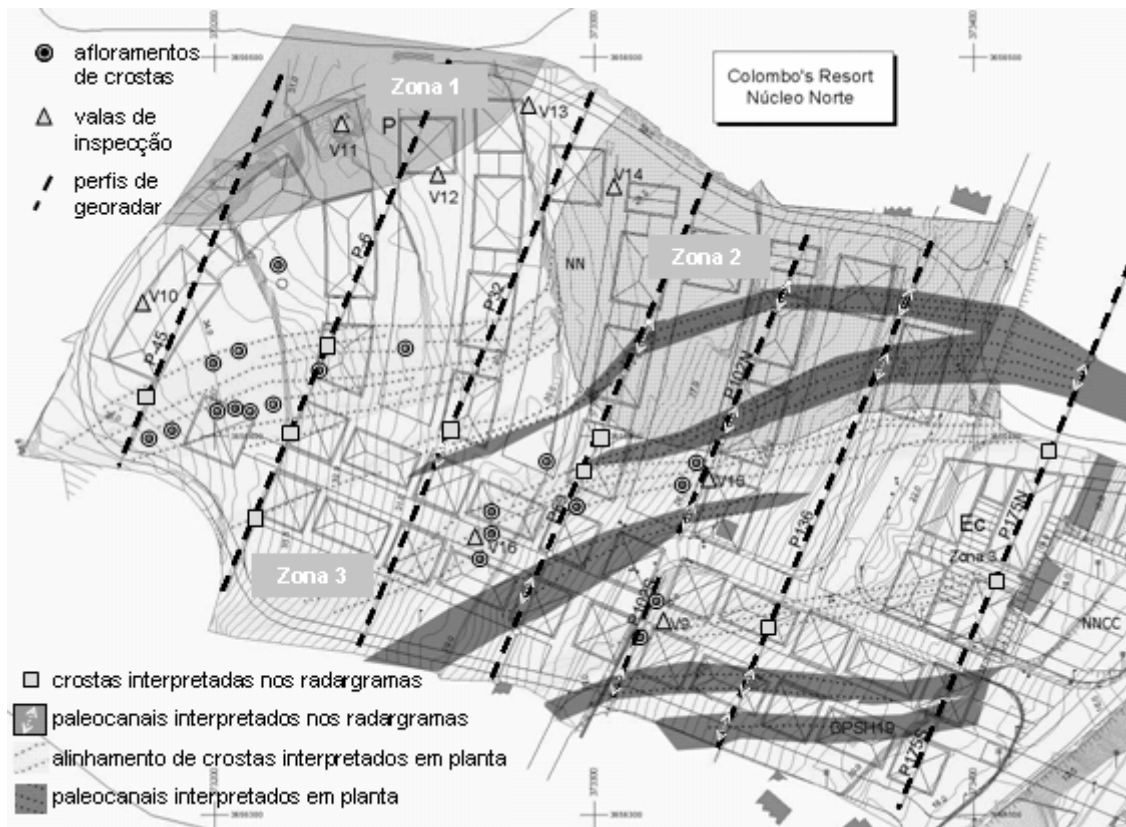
Planta interpretativa com zonamento no núcleo Norte (adaptado de Silva et al, 2002).
